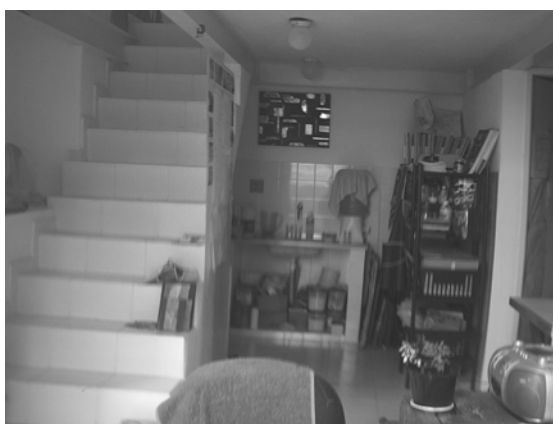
Primeiro pavimento do apartamento 102 (autora, 2005).
